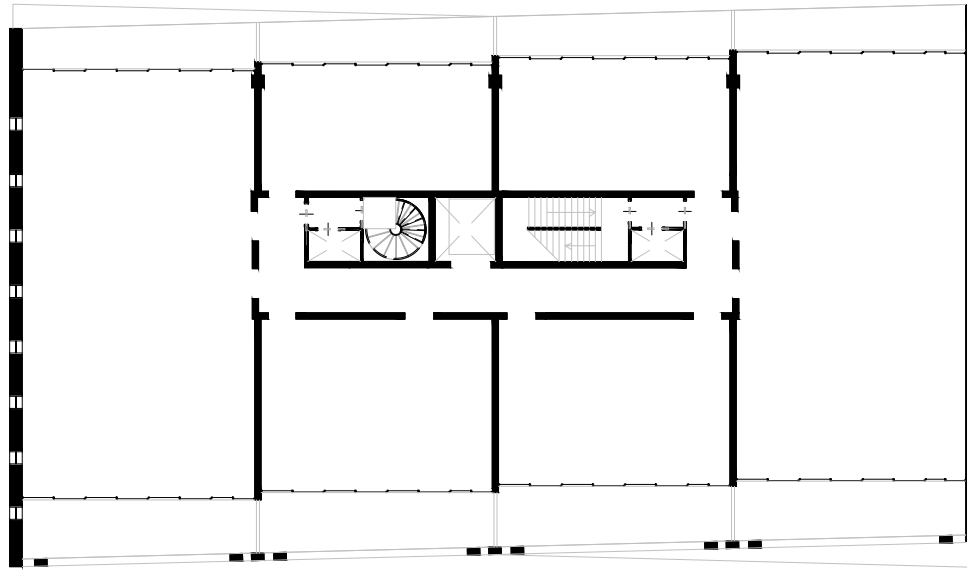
Plano de planta tipo sin distribución del edificio Patch 22 a escala 1: 200.
